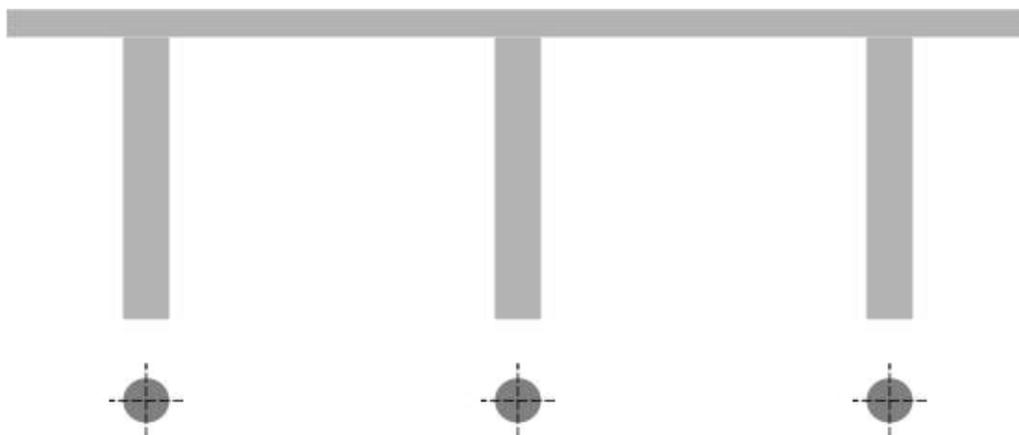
Фрагмент конструктивной схемы здания из монолитного железобетона с колоннами круглого сечения
